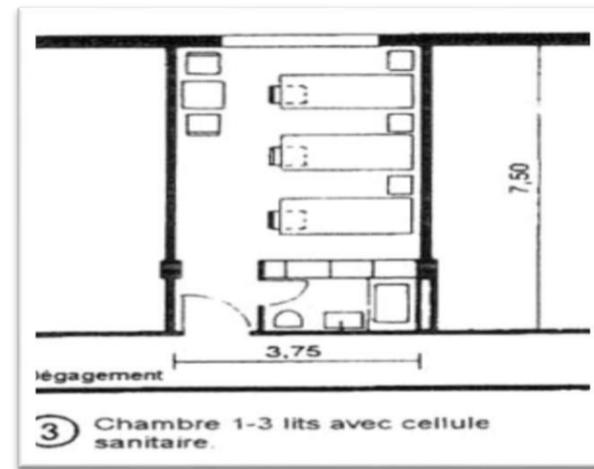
24: Plan exemple d'une chambre avec sanitaire (les éléments des projets de construction, neufert 8-ème édition)
